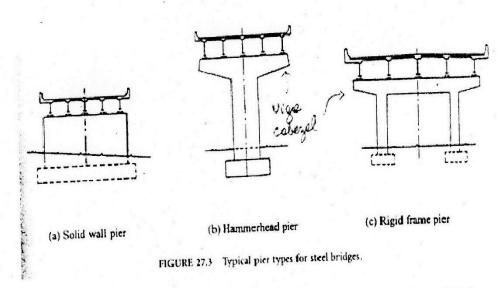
Tipos de pilas típicas para Puentes de acero (Chen y Duan 1999).
